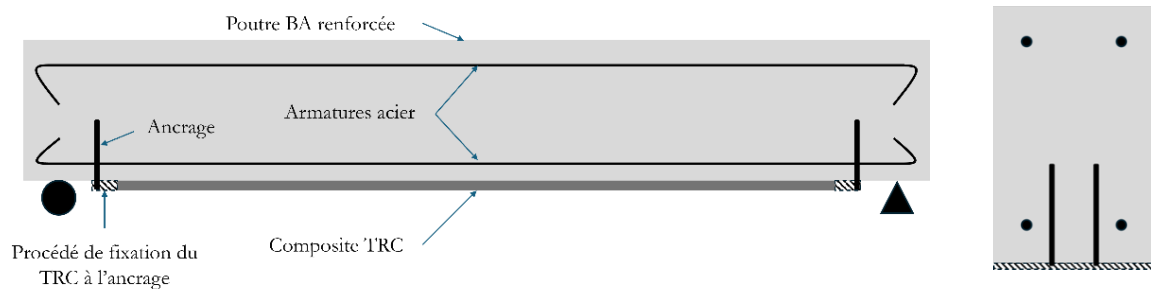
Schéma de principe d'une poutre renforcée par un TRC avec ancrage (Gauche) coupe longitudinale (Droite) coupe transversale
